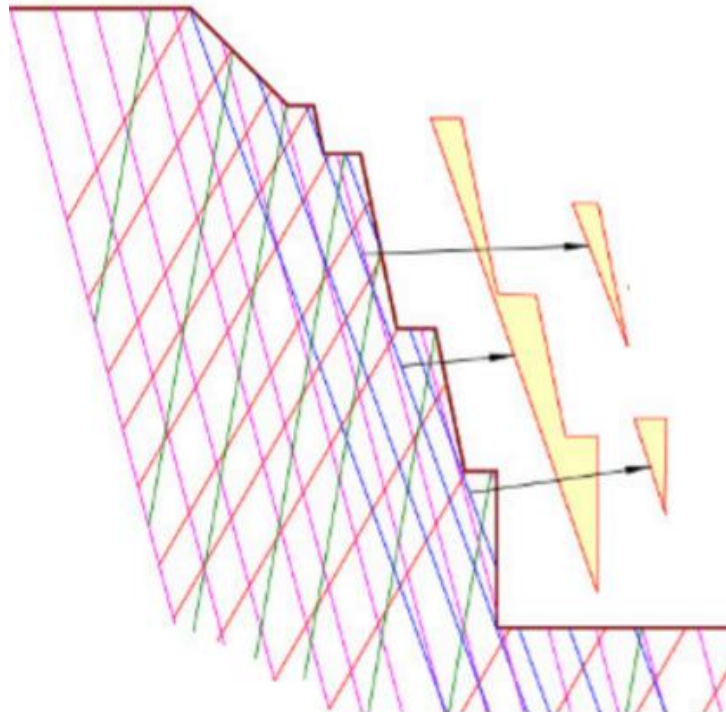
Planos transversais principais e juntas com a secção transversal da escavação
